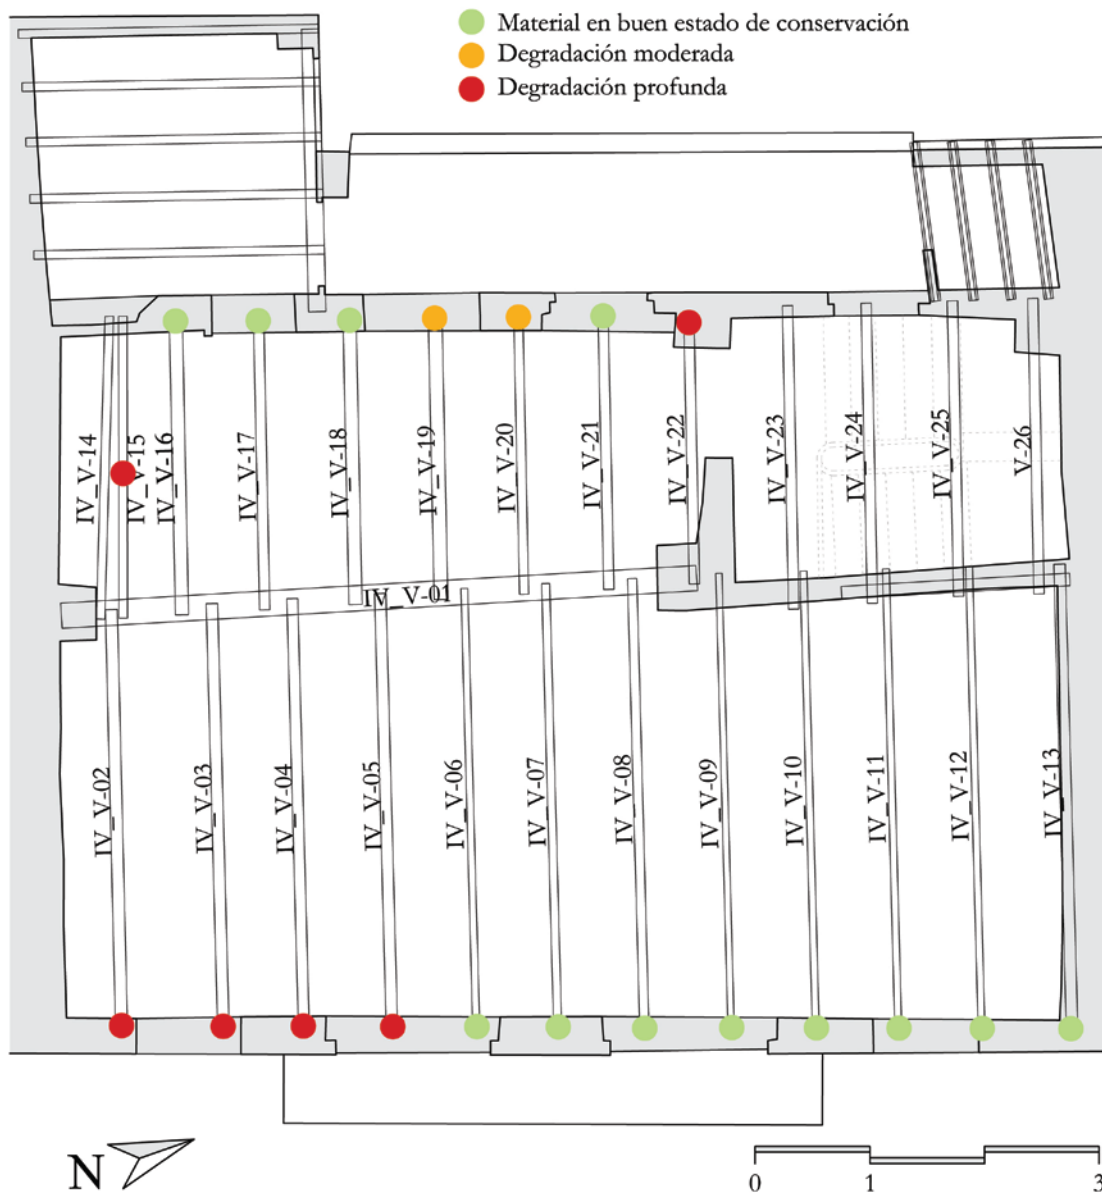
Estado de conservación real de la estructura comprobado tras el levantamiento de la estructura secundaria de la cubierta.
